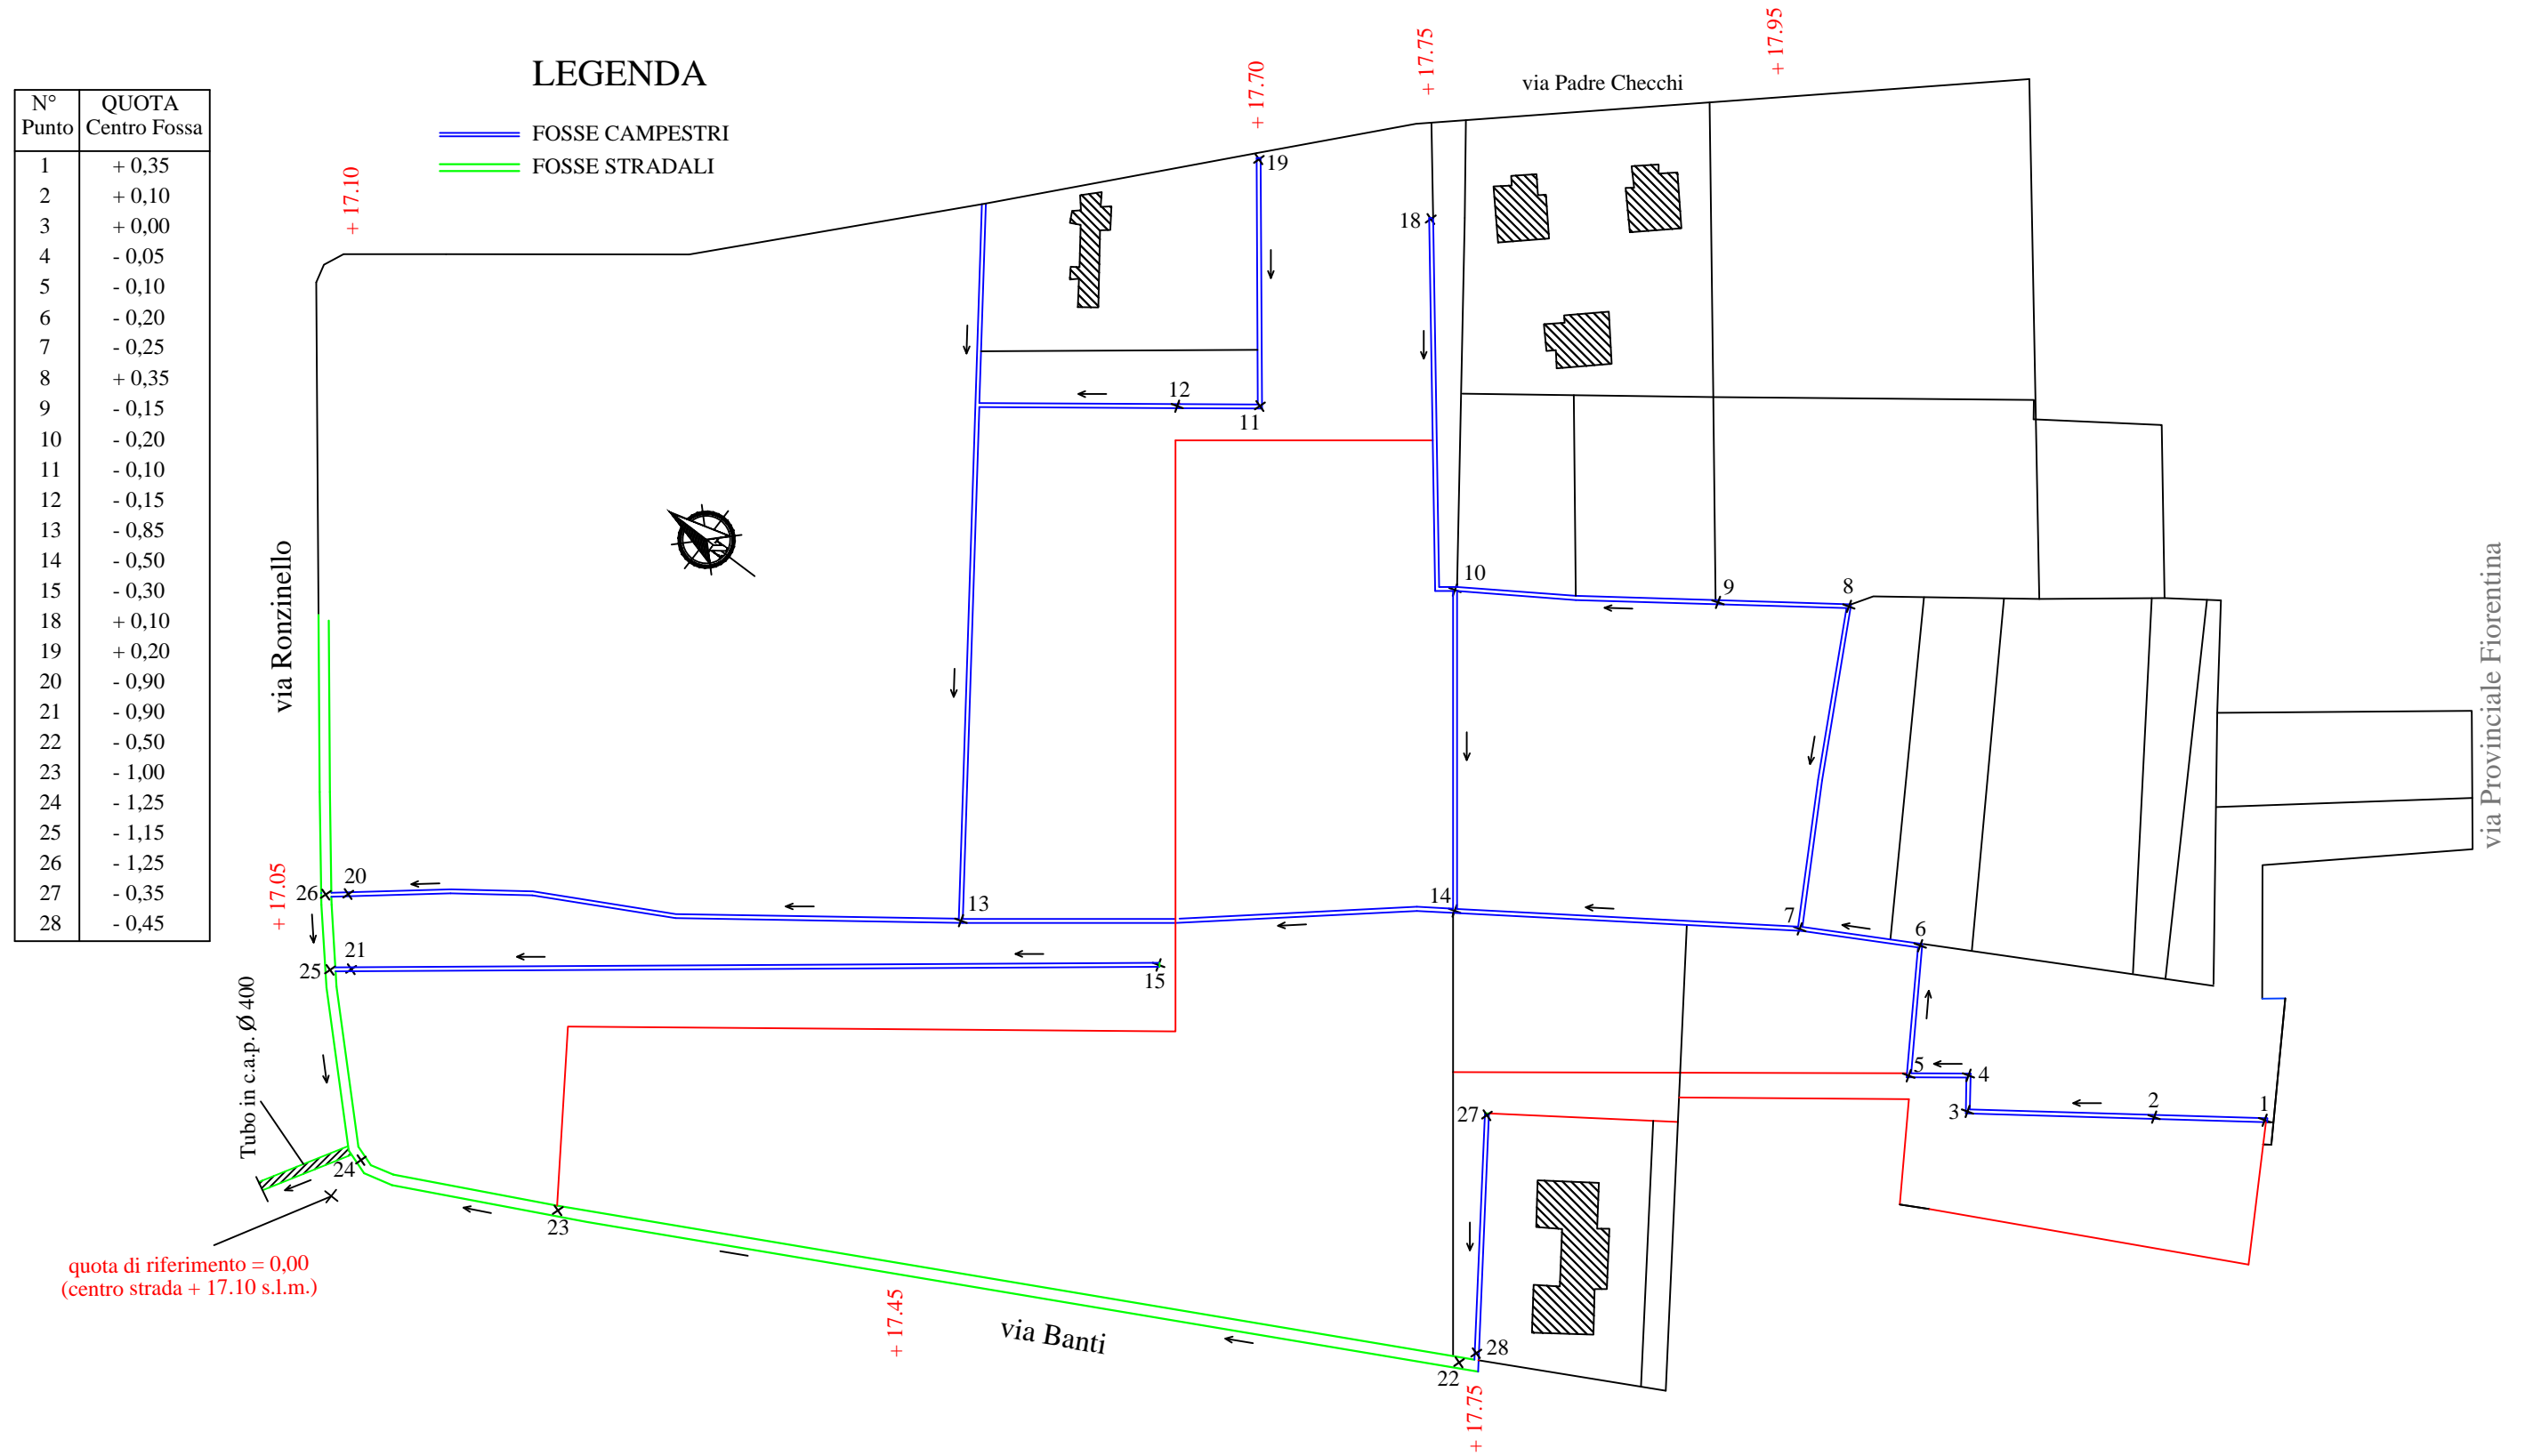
Planimetria generale con indicazione delle quote di progetto (scala 1:1000)
